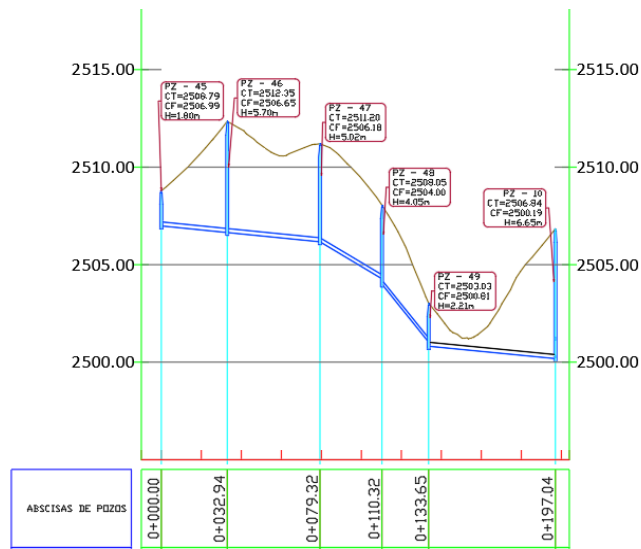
Perfil de la red secundaria 5, se detallan los pozos nro. 46 y 10.
